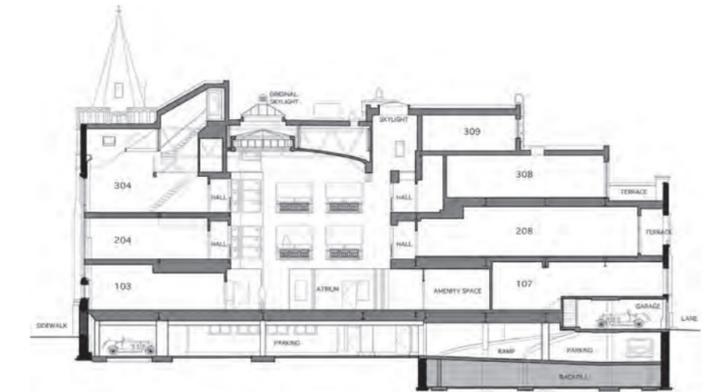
The Church Lofts, sección transversal oeste/este mirando al norte.
